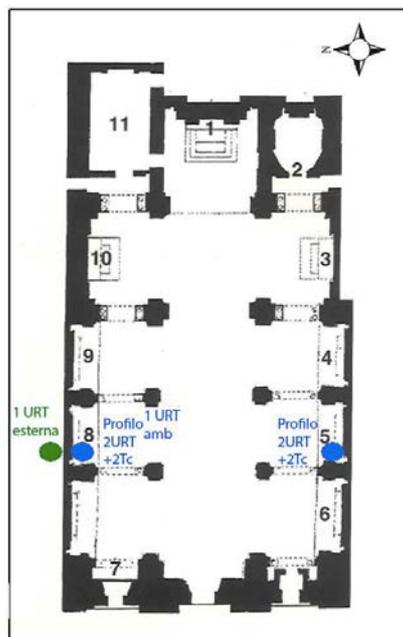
planimetria della chiesa con collocazione dei sensori all'esterno e all'interno.
